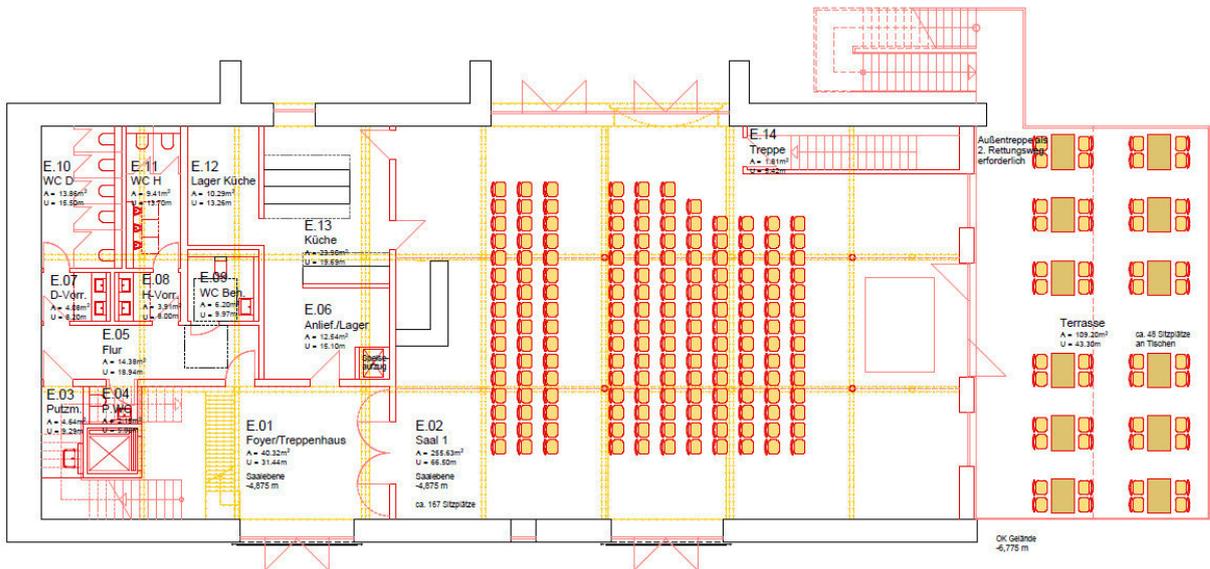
| Grundriss EG | IB Koch; 2017
